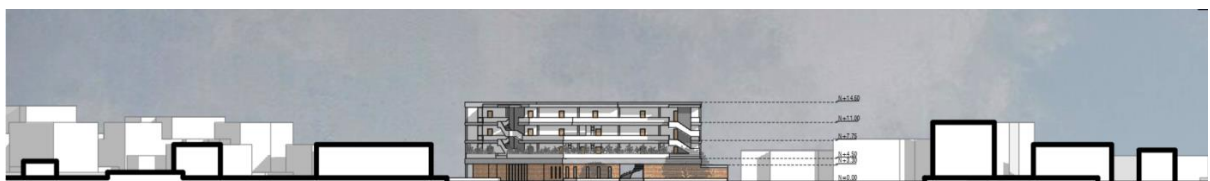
Elevación oeste - Proyecto definitivo. Elaboración propia.
